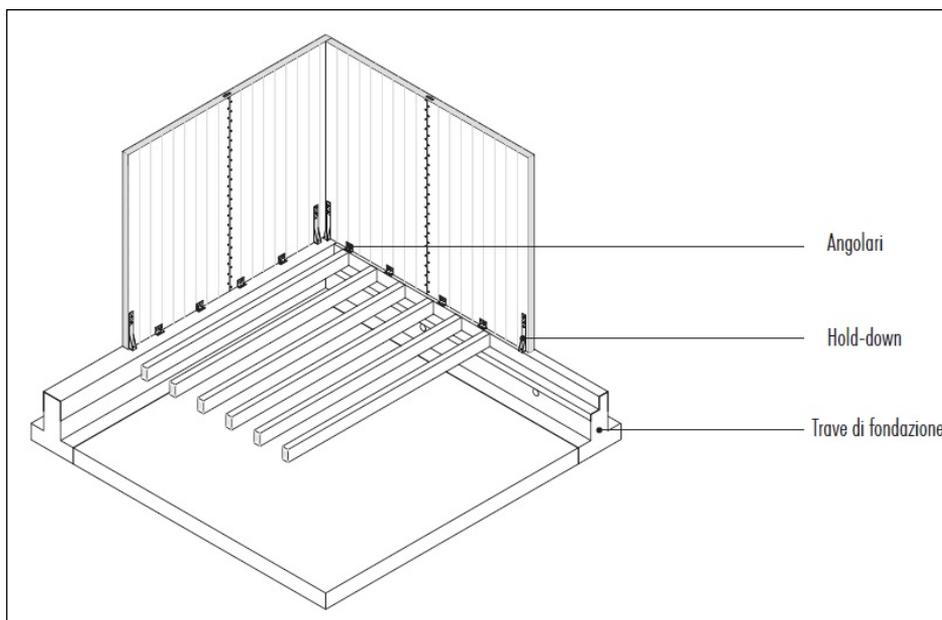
Esempio di collegamento parete XLAM- struttura di fondazione.
